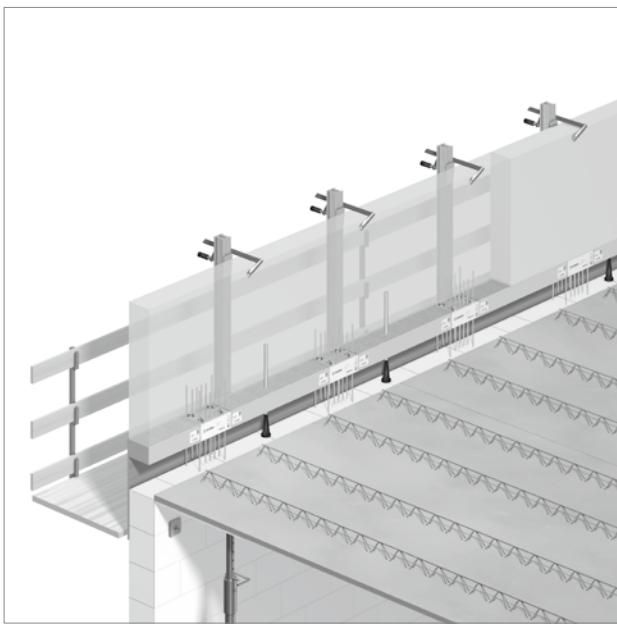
Schöck Isokorb® CXT Typ AP mit Combar® Element-Montagestütze:
